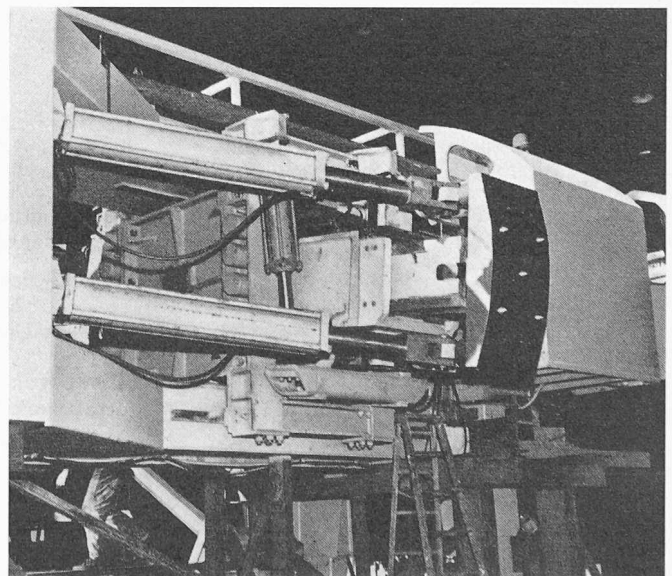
Robbins-Maschine Modell 161, Detailansicht der Vorschubpressen und des Querriegels mit den Widerlagerplatten
